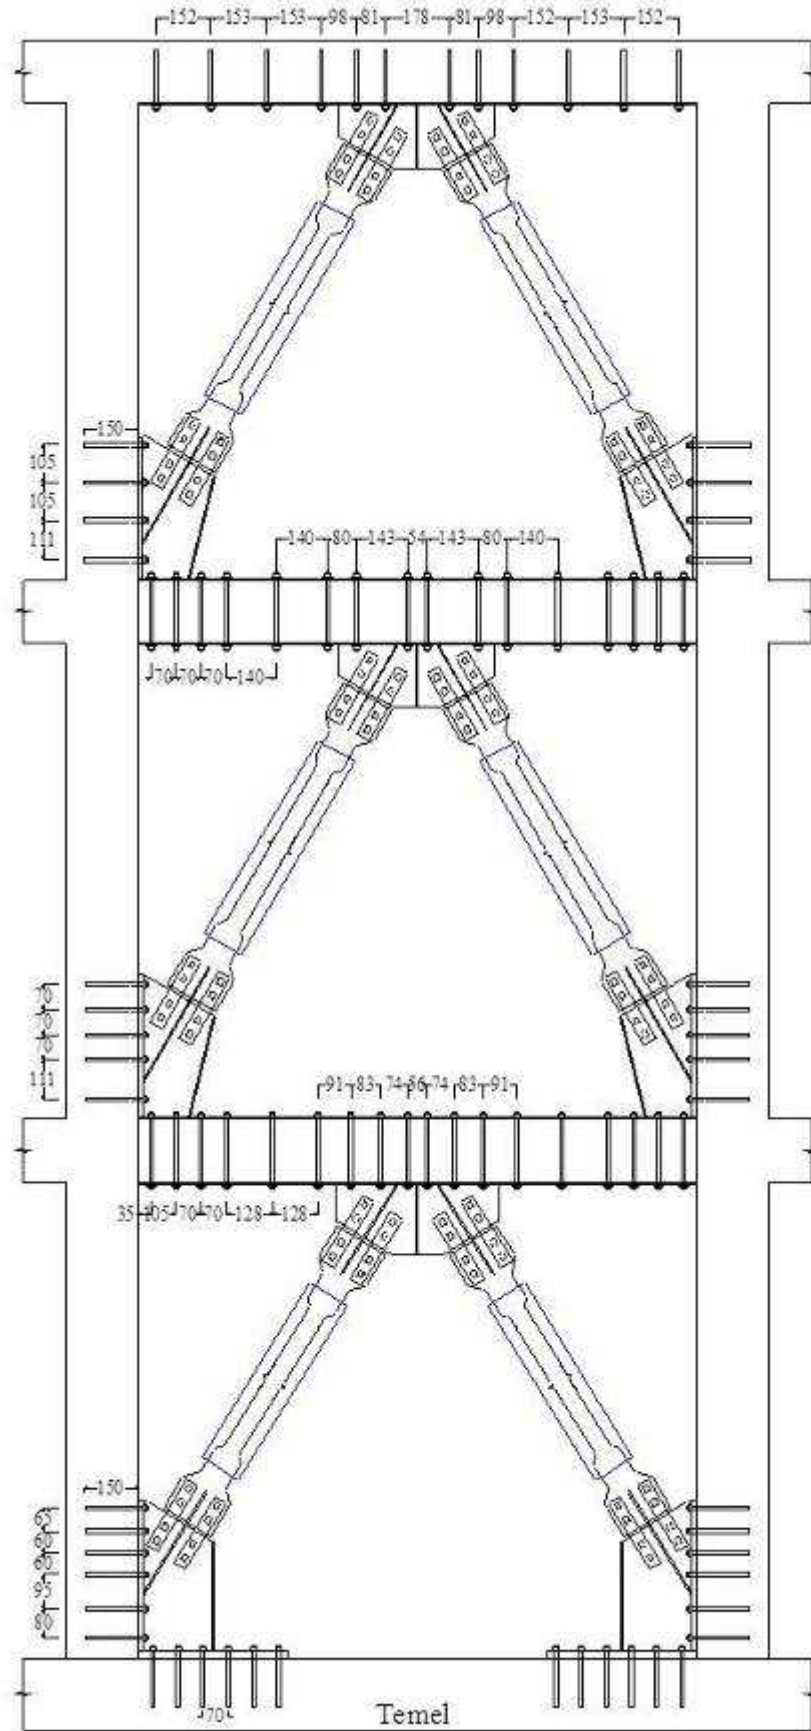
Kiriş orta açıklığında bağlantı detayı
